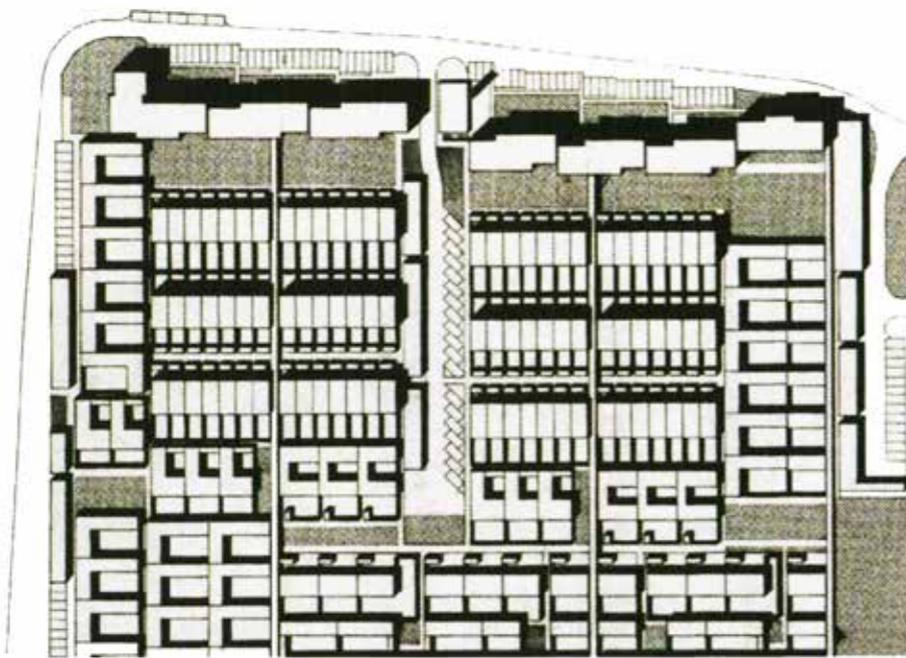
Roland Rainer, Puchenau I, Lageplan
